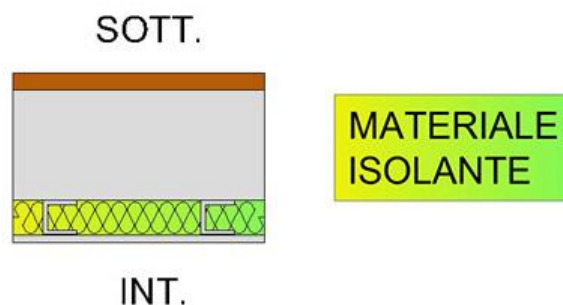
schema di isolamento del solaio di sottotetto dall'intradosso (Fonte ANIT)
